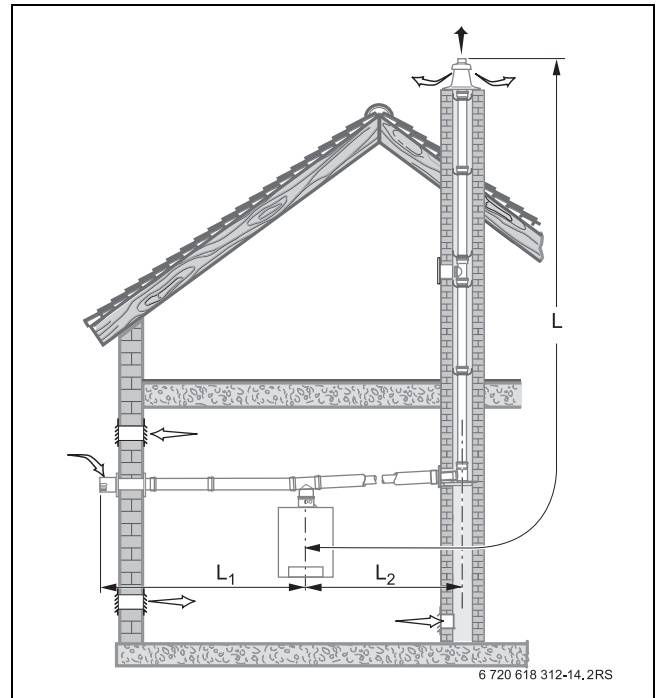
C_{53x}: Abgasführung im Schacht Ø 100 mm, Luftführung an der Fassade
